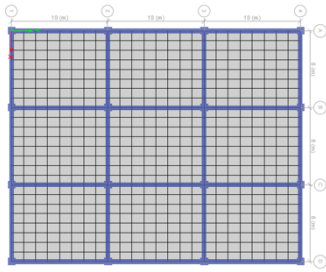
Planta de modelo de 30 niveles orientado en Eje Y
